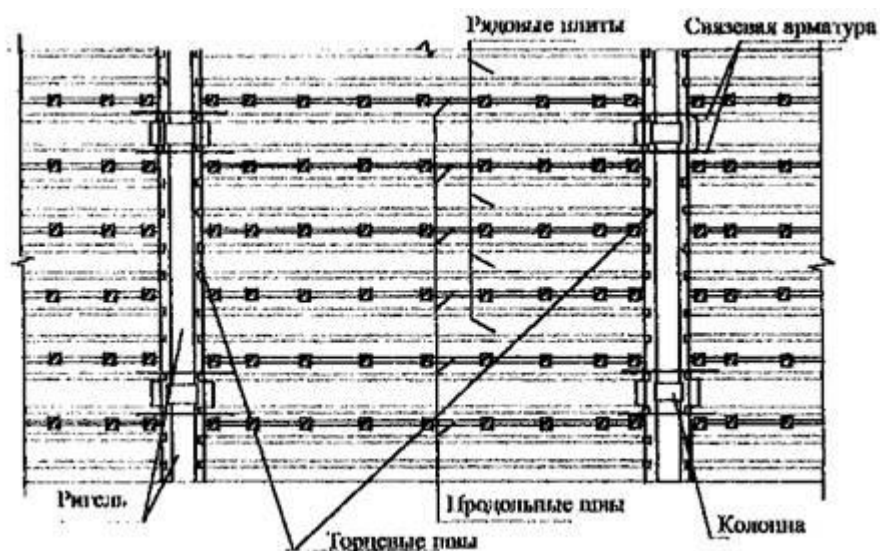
Фрагмент плана сборного перекрытия из плит 2Т
